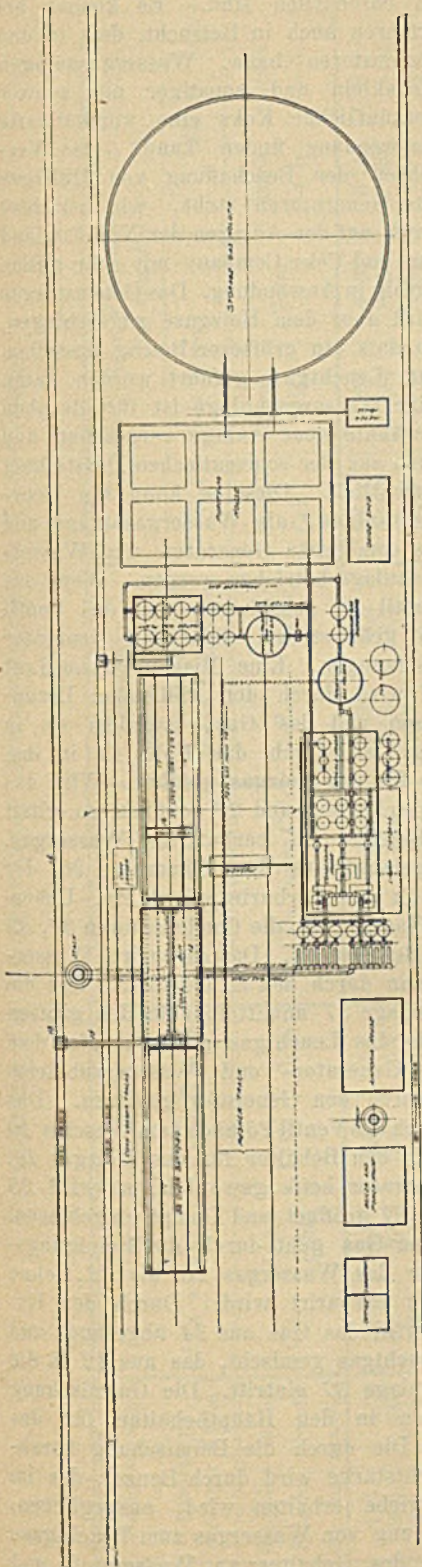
Lageplan der Koksöfenanlage in Everett.
